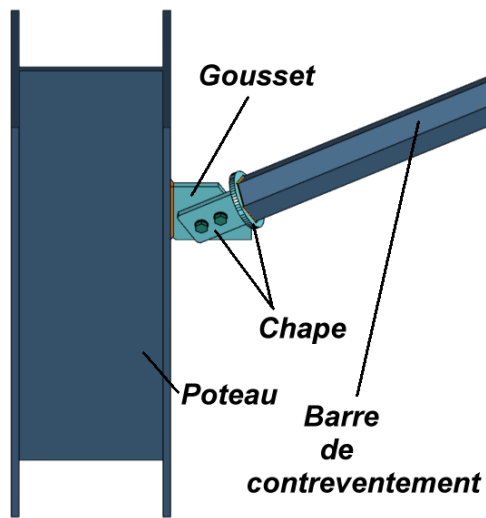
Articulacion poteau-barre de contreventement en tube rond avec chape sur gousset
